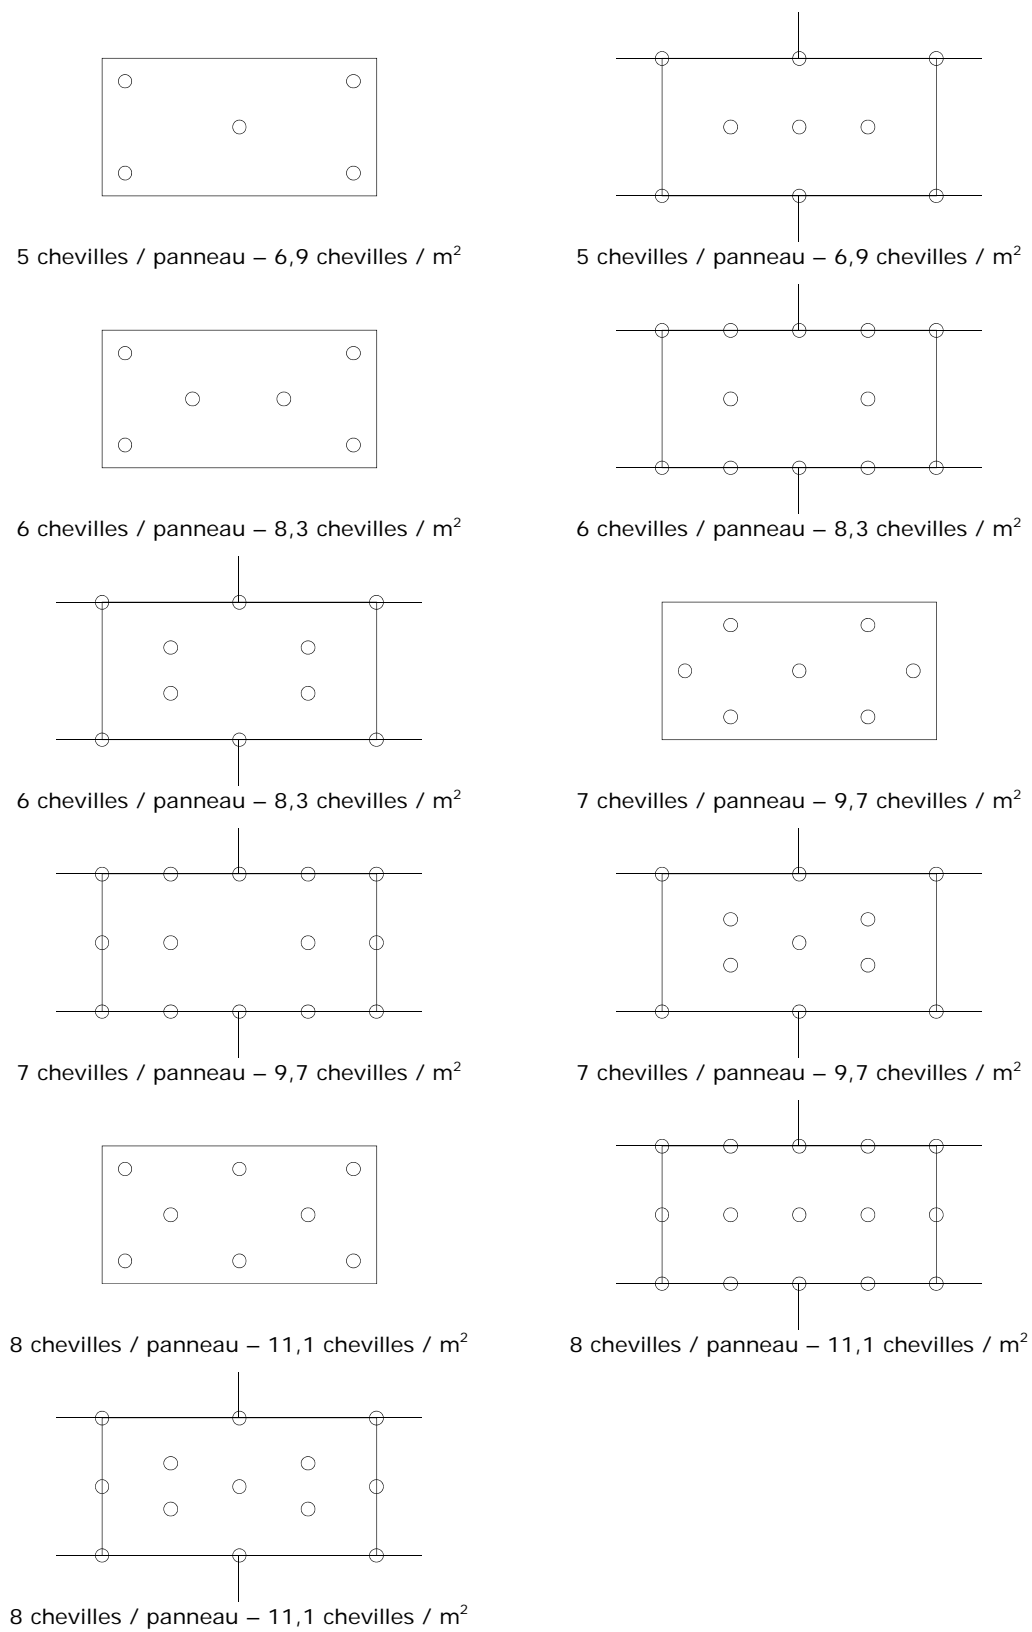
Plans de chevillage - panneaux de dimensions 1200 x 600 mm
